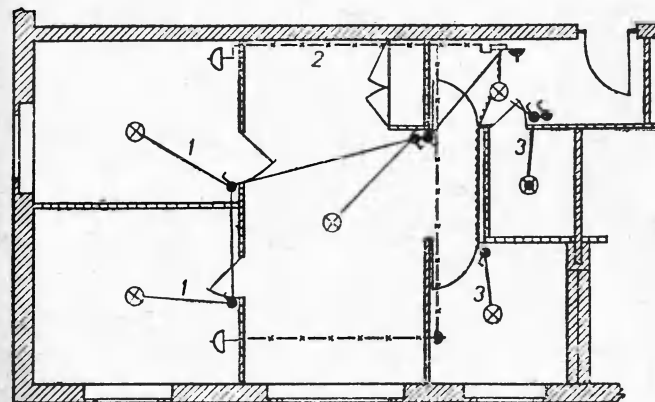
Схема скрытой электропроводки в перекрытиях пола и потолка:
